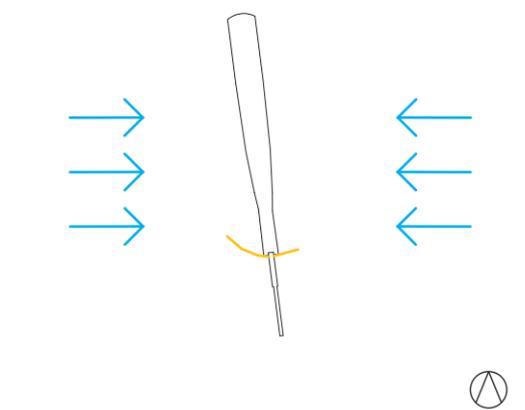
Grundriss Bergisel-Schanze Innsbruck M 1:2.000
